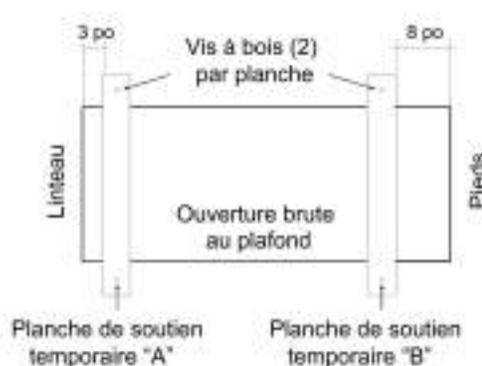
EMPLACEMENT DES PLANCHES DE SOUTIEN
